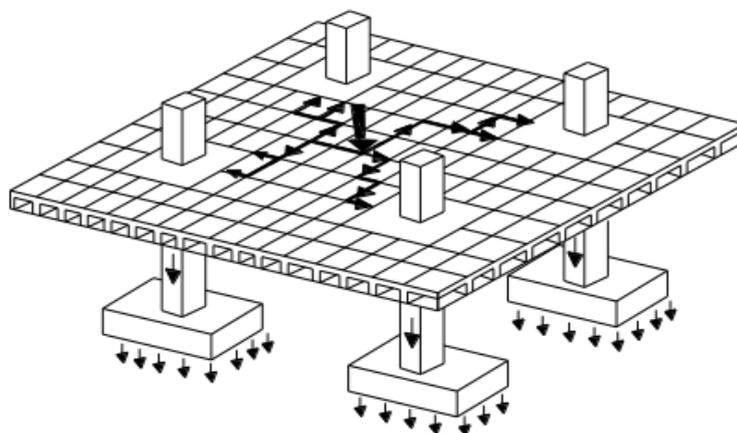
Trajectoria das cargas nas lajes aligeiradas(Trindade, 2009).
